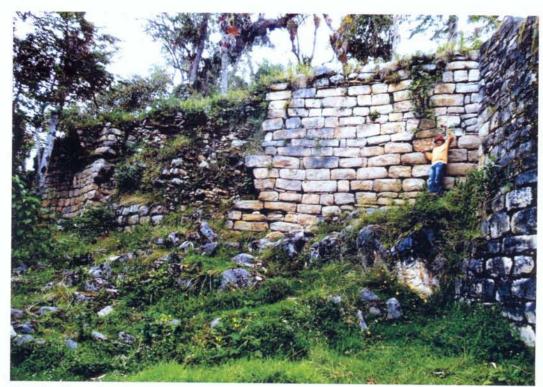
Muro colapsado en la parte alta de la fortaleza de Kuélap.
